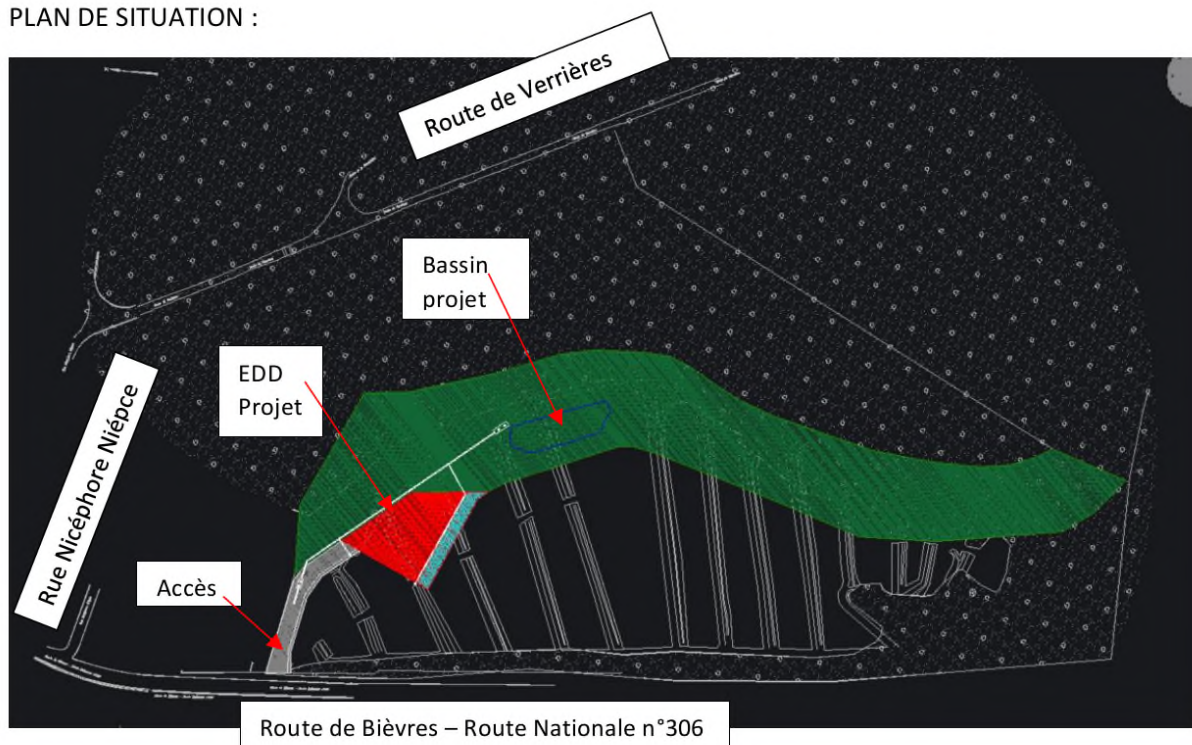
Plan masse de la parcelle du projet – BY Bâtiment
